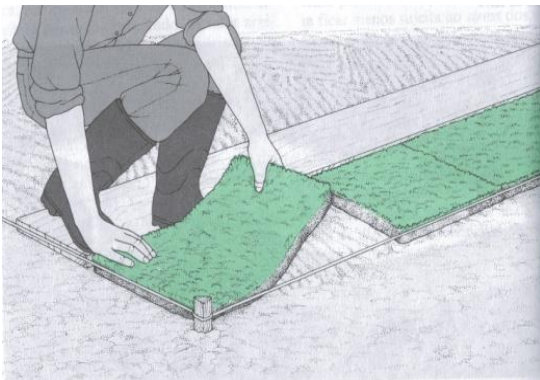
(a) (b) - Colocação de tapete de relva tipo tijolo
